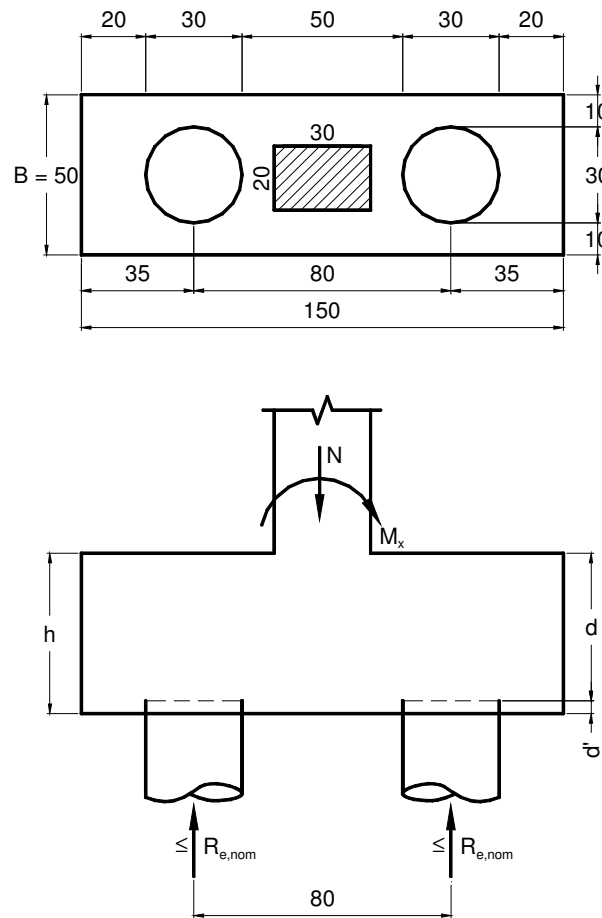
Dimensões (cm) do bloco sobre duas estacas.
